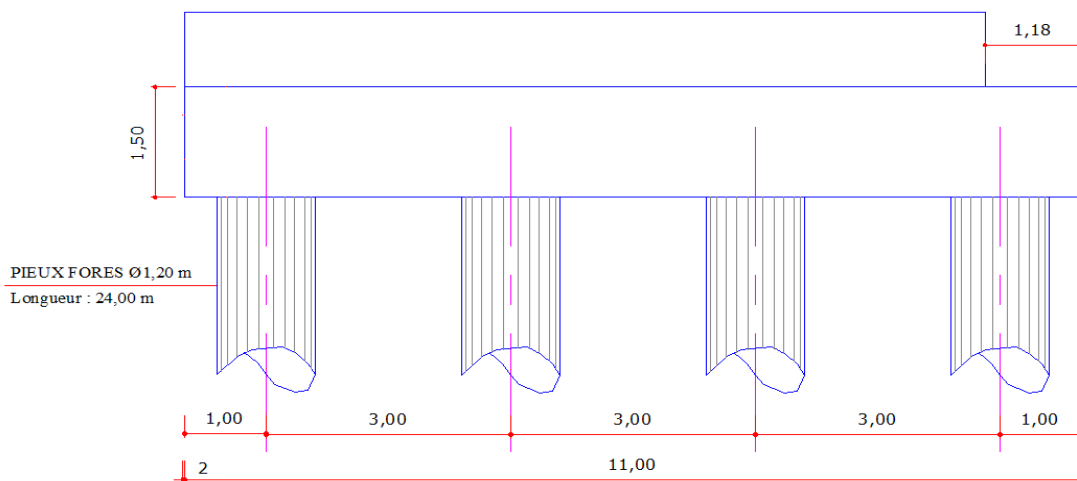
Schéma semelle sous culée sens longitudinal.
